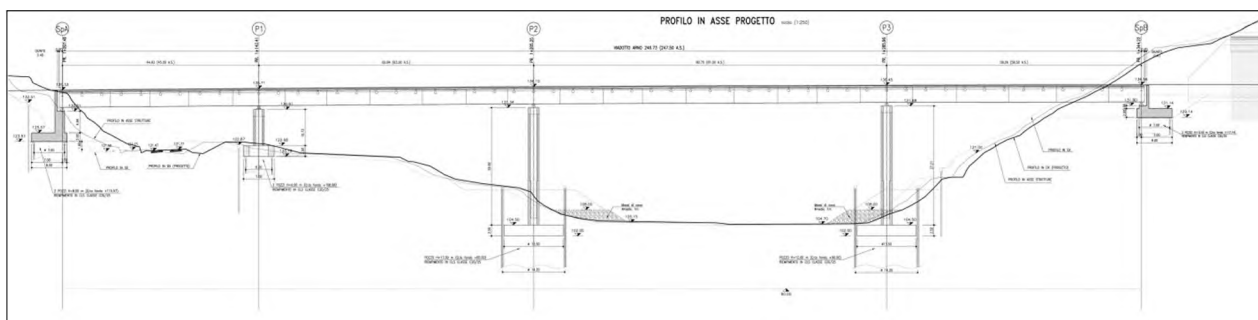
Profilo longitudinale (stralcio planimetrico da elab. STR5503)
